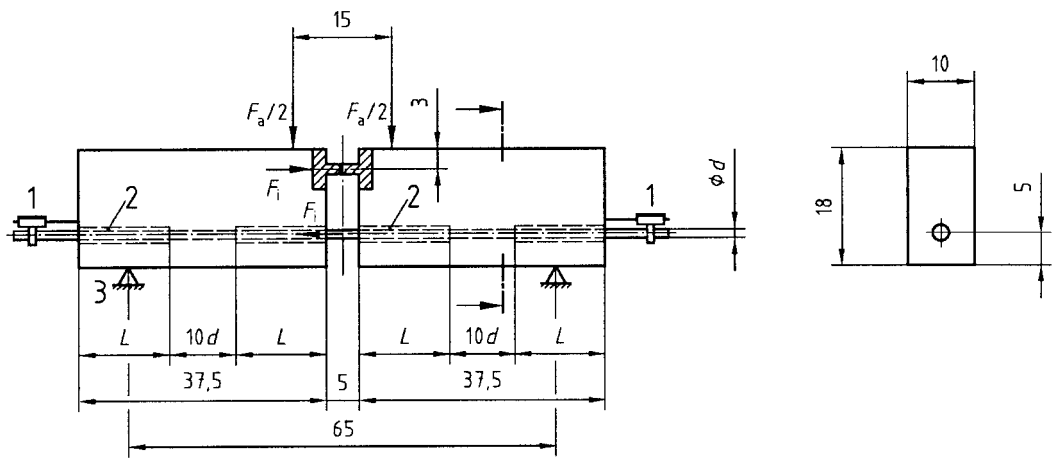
Dimensiones de la rótula para la viga tipo B ($d \geq 16$ mm)
